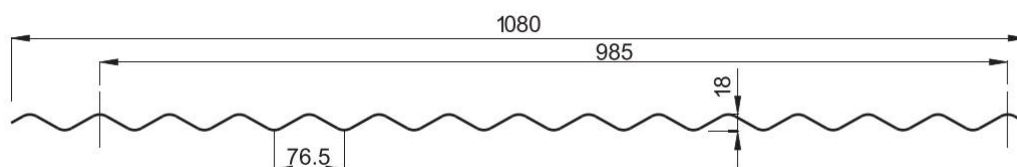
Exemplo de Telha Metálica Ondulada Zincada.
